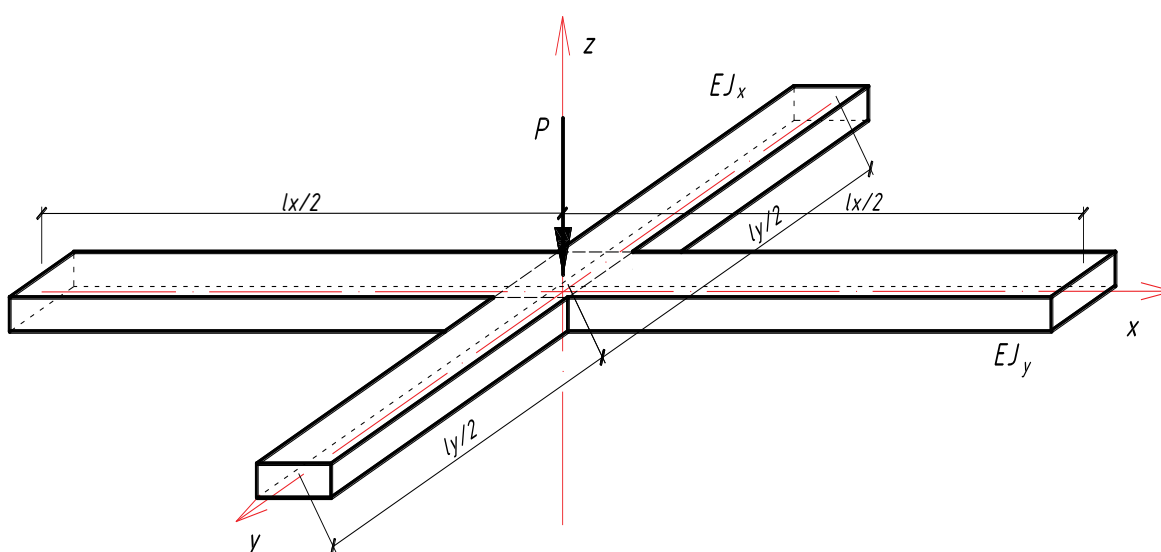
Фрагмент крестообразного пересечения железобетонных балок регулярной системы балок на упругом основании
